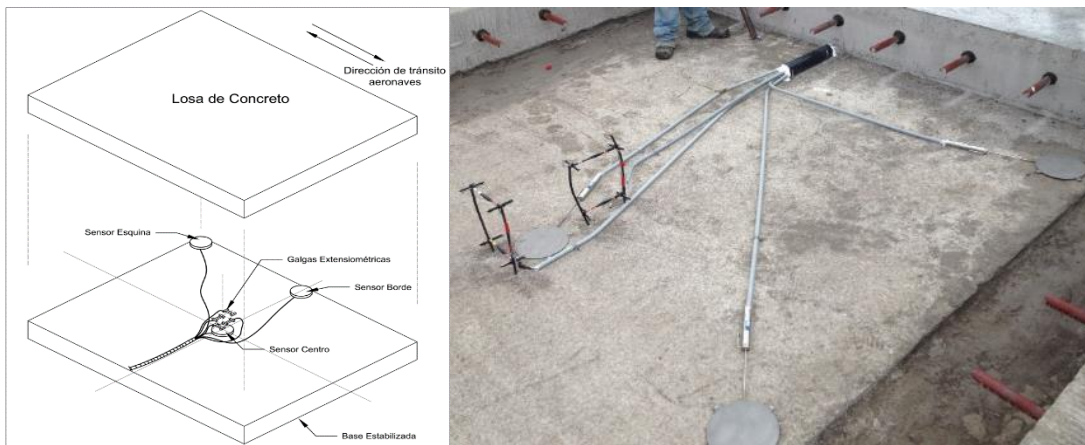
Ubicación de instrumentación instalada en la puerta tres, AIJS
